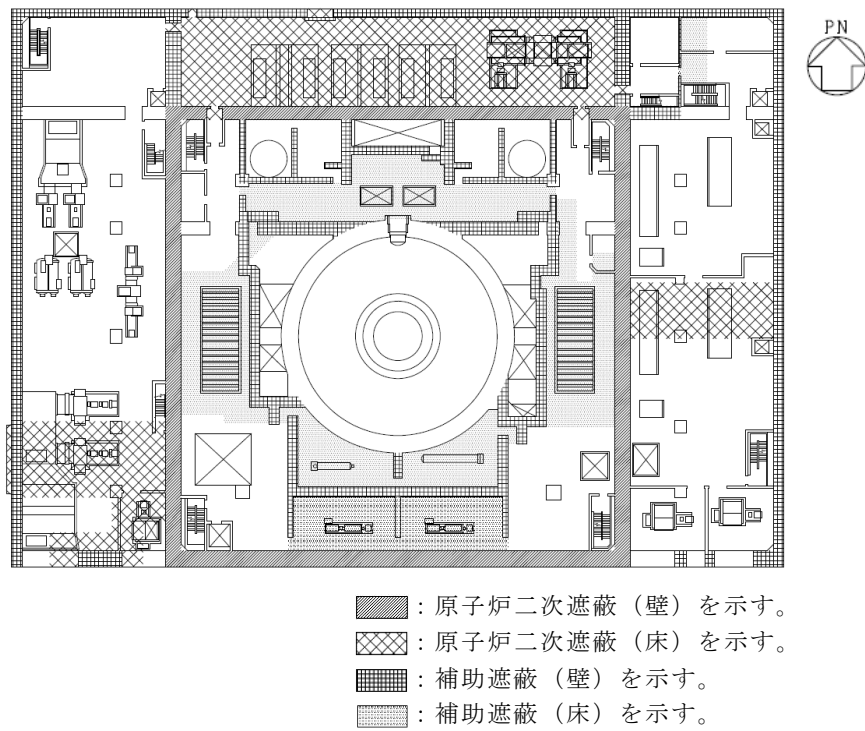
(6) 原子炉二次遮蔽及び補助遮蔽（原子炉建物）の範囲の平面図
